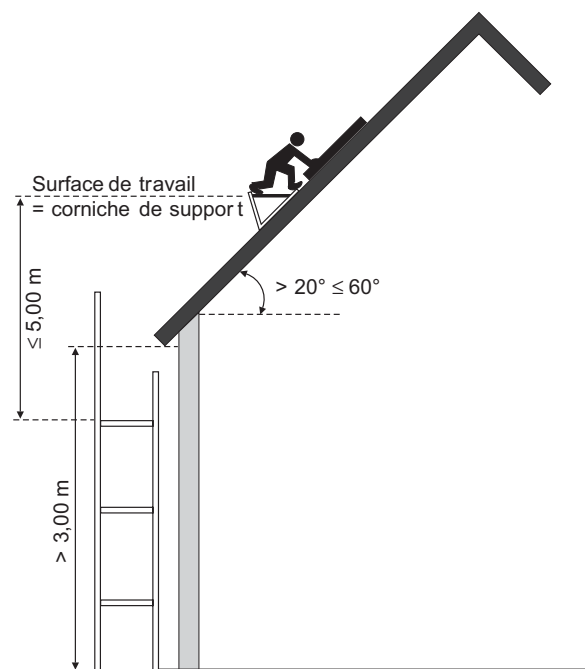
Grilles de protection pour travaux en toitures inclinées
